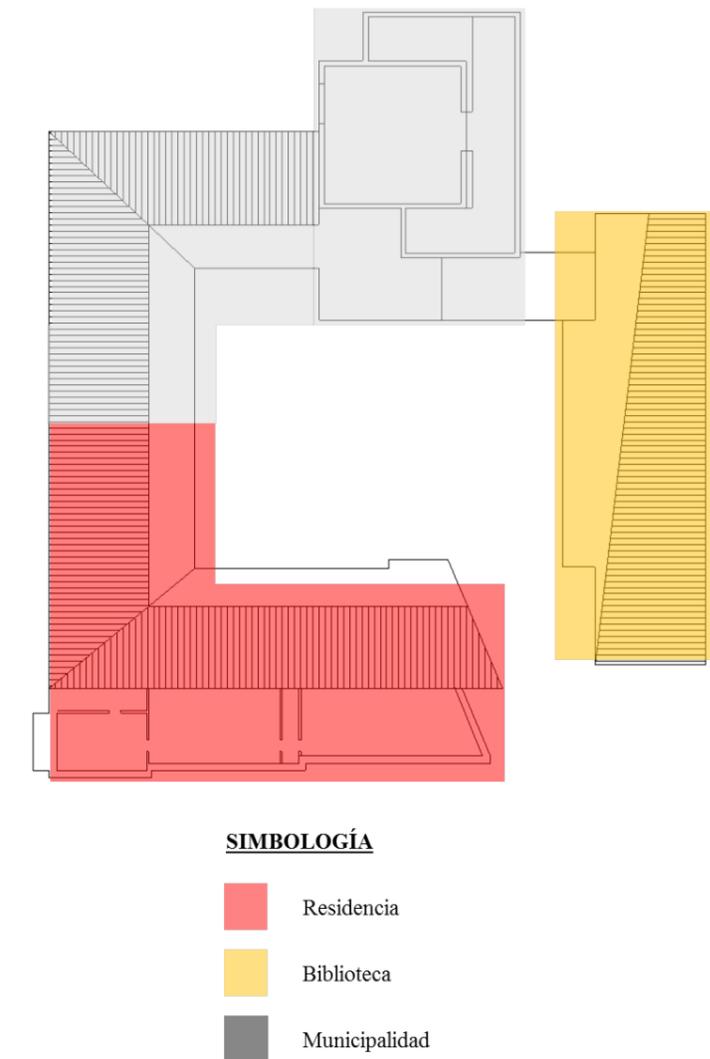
Ayuntamiento Saynatsalo - Distribución espacial de planta alta.
